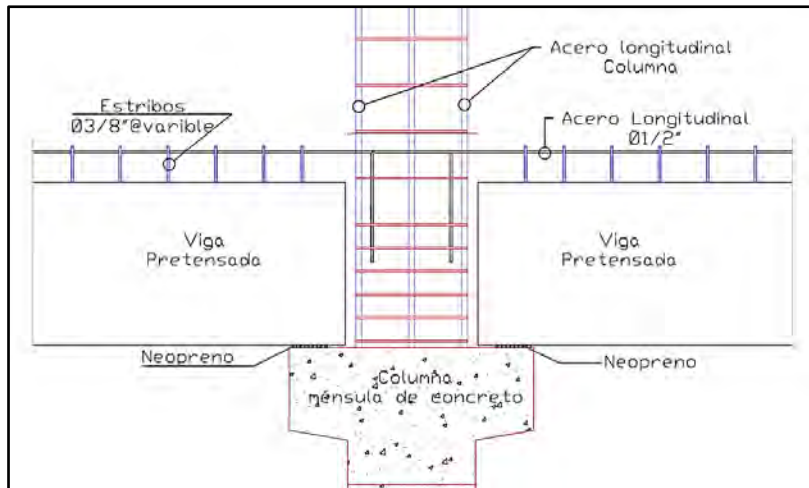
Detalle de conexión viga-columna no emulativa semirrígida (Fuente propia)
